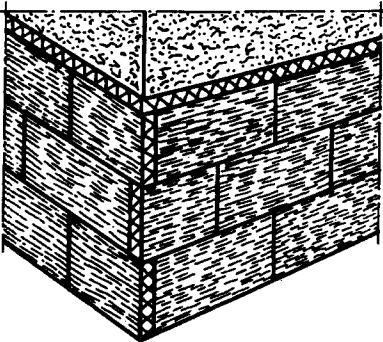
Расположение плит утеплителя с наружной стороны угла
